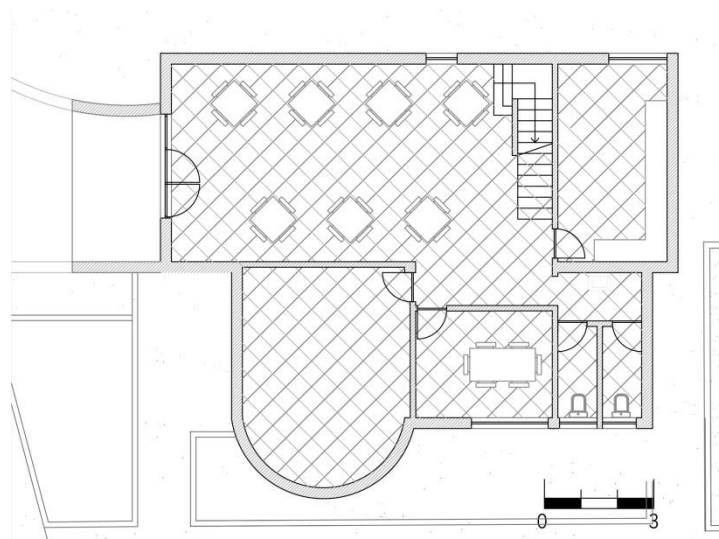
Planta do piso -1 (O restaurante)³⁰
